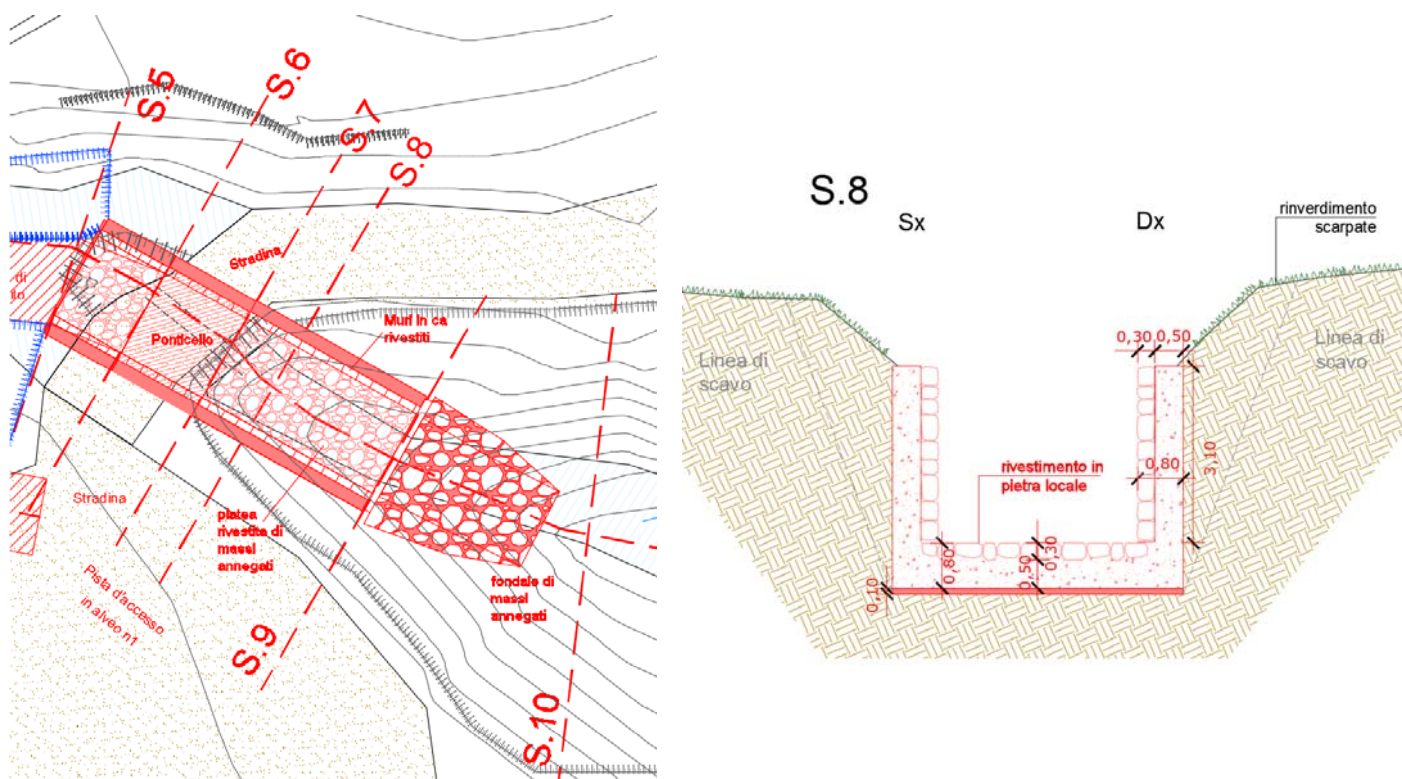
planimetria e sezione di progetto di parte degli interventi nella zona C
